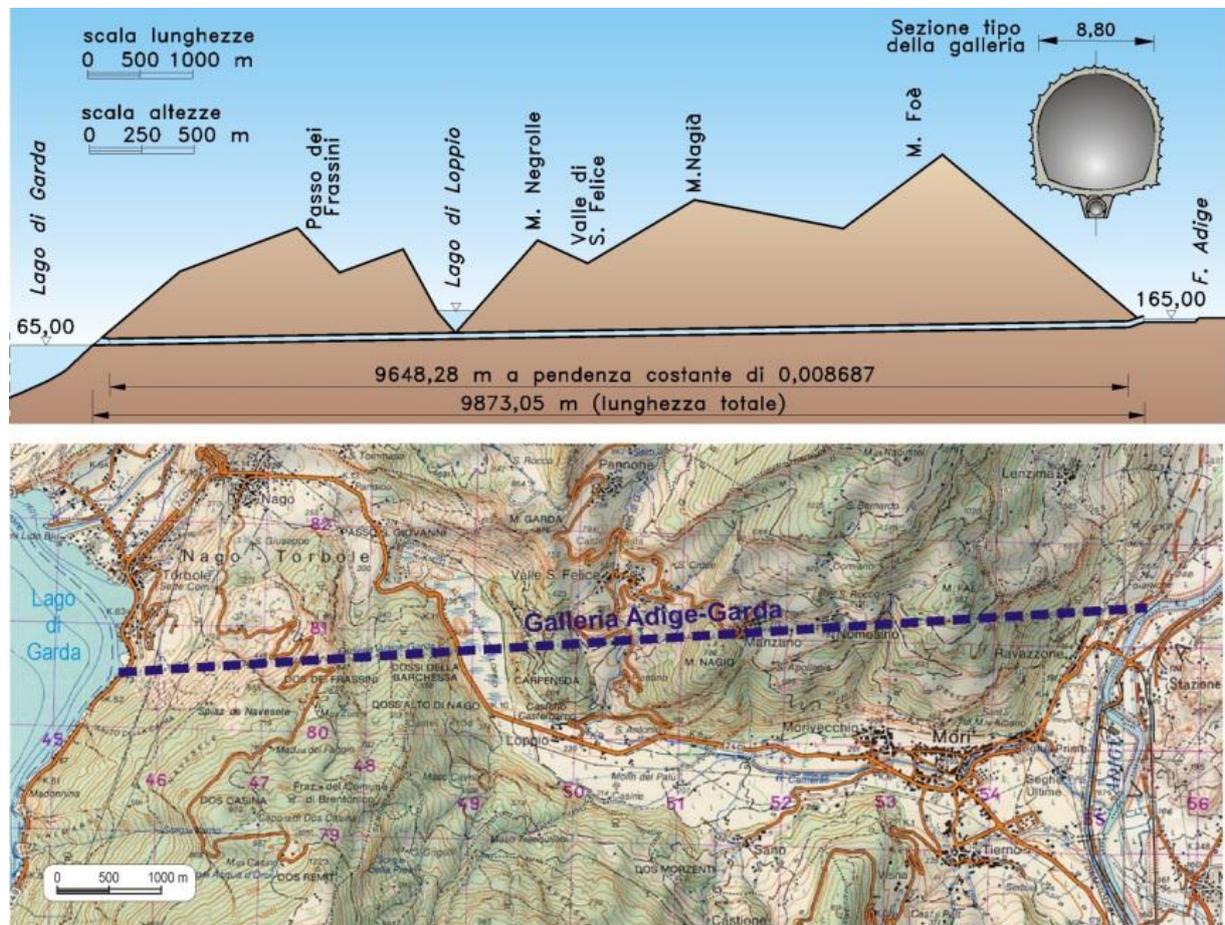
Galleria Adige-Garda: profilo longitudinale, sezione trasversale e planimetria.
